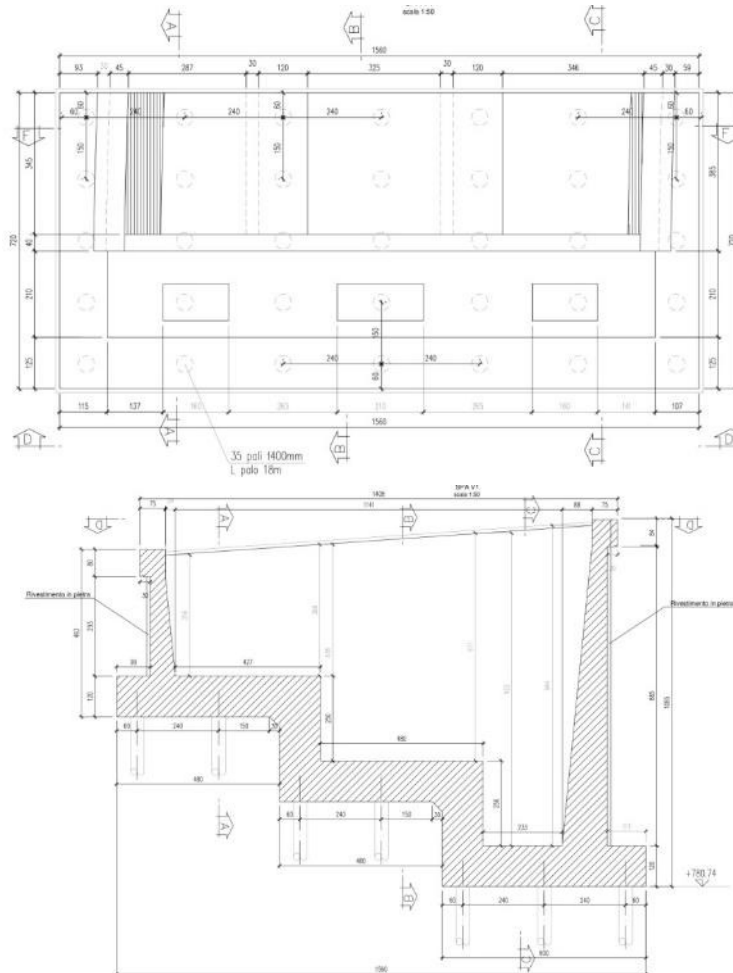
Spalla A: sezione longitudinale e pianta
